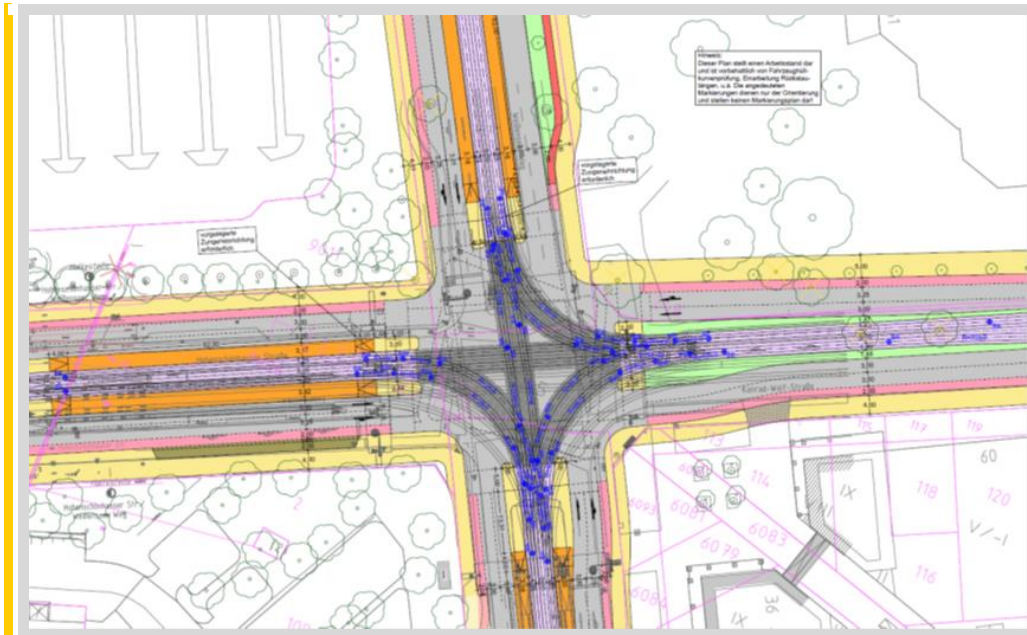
Lageplanausschnitt Vorzugsvariante
